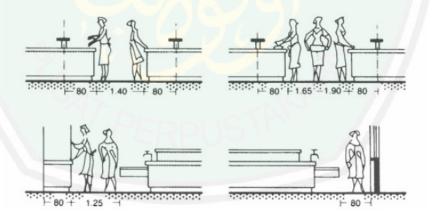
Contoh layout lab Power Research Universitas Newcastle
